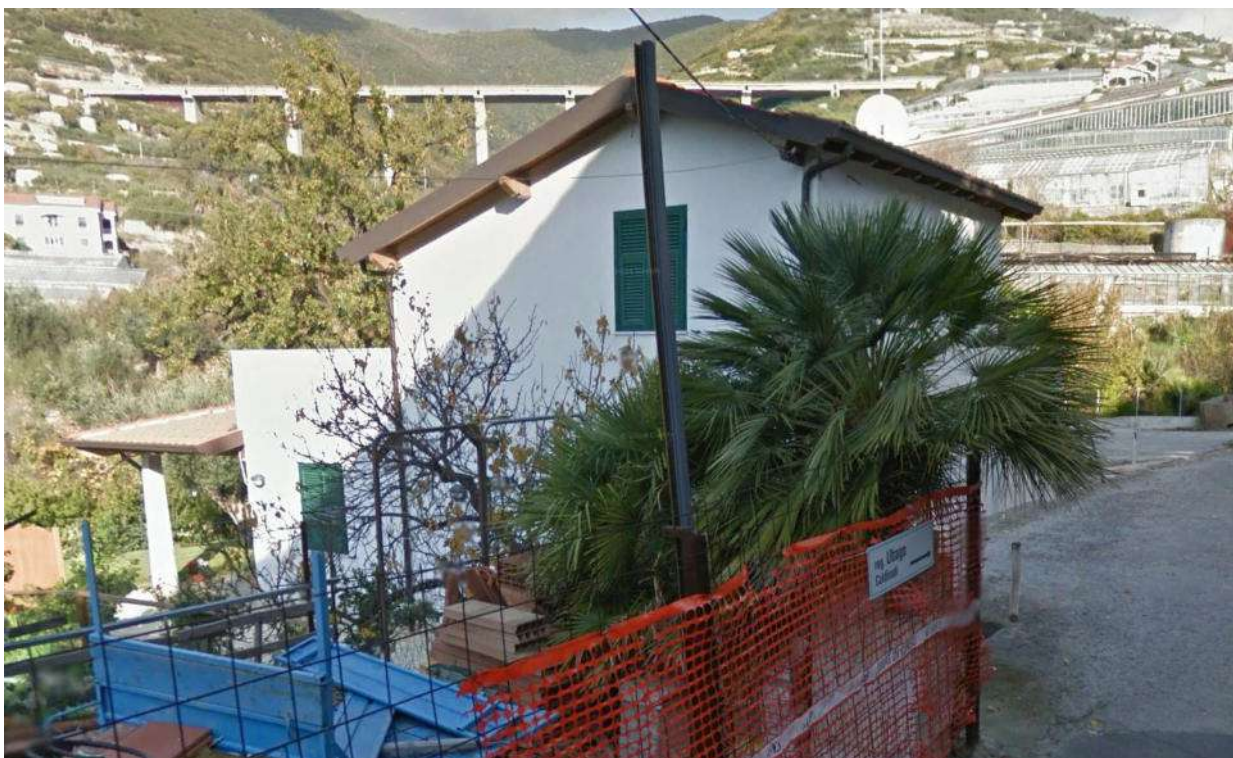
FOTO IMMOBILE DALLA STRADA DEI GAROFANI
